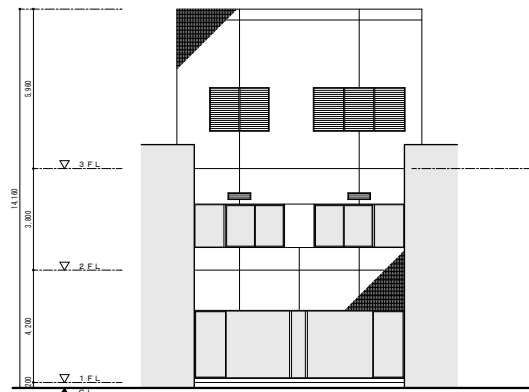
図名	精神医療センター本館棟 南側立面図	縮尺	(A1) 1:100 (A2) 1:200
